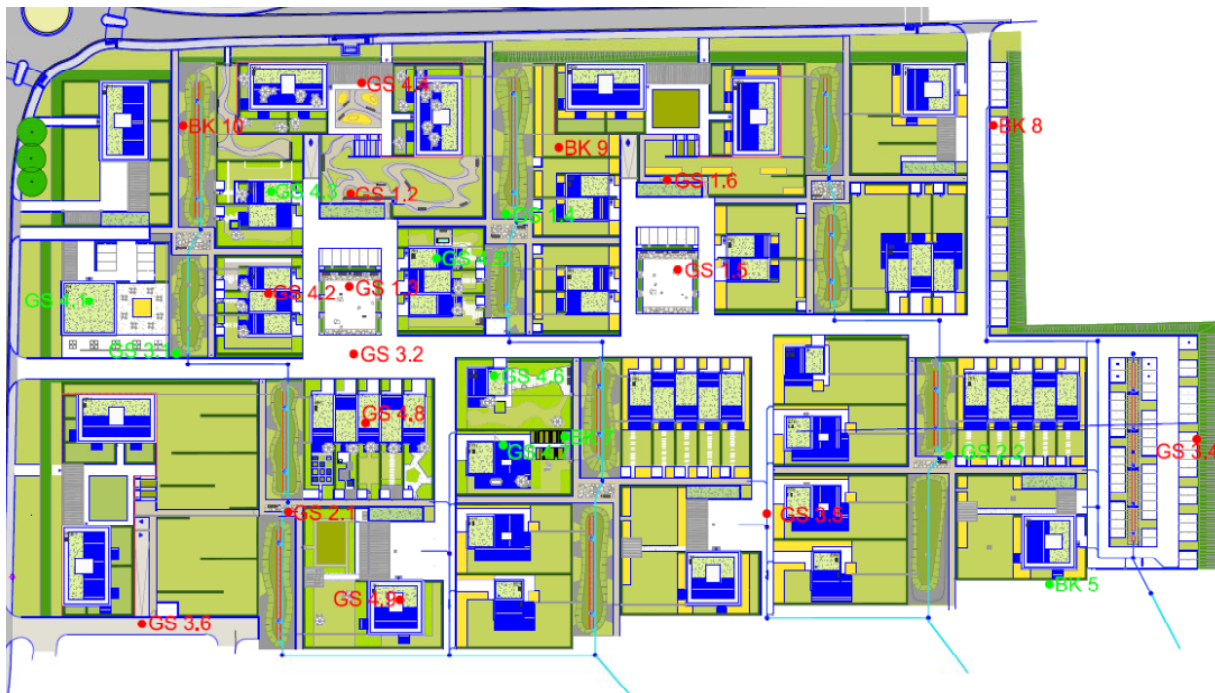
Lageplan der Aufschlusspunkte mit Bohrprofilen nach [1] und [2]
